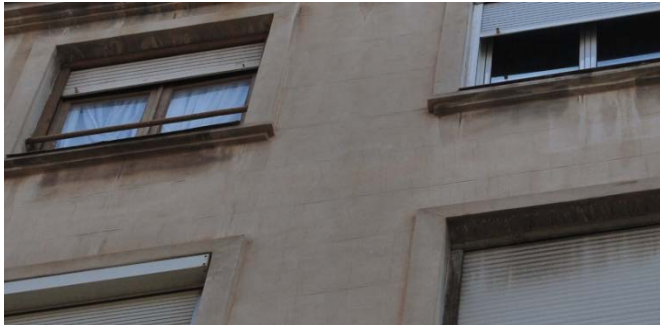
Fisuras. 2015. Fuente propia.
